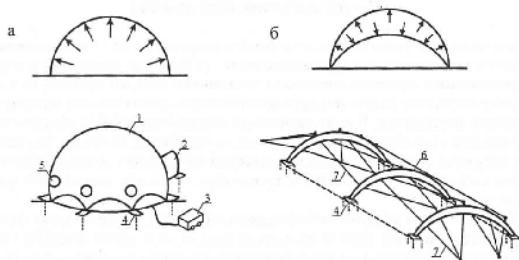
Пневматические конструкции. Принцип действия и схемы: а – воздухоопорная; б – пневмокаркасная; 1 – воздухоопорная оболочка; 2 – шпоз; 3 – компрессор; 4 – анкер для крепления к земле; 5 – окно – иллюминатор из светопрозрачного пластика; 6 – пневматическая арка; 7 – продольные связи – растяжки
